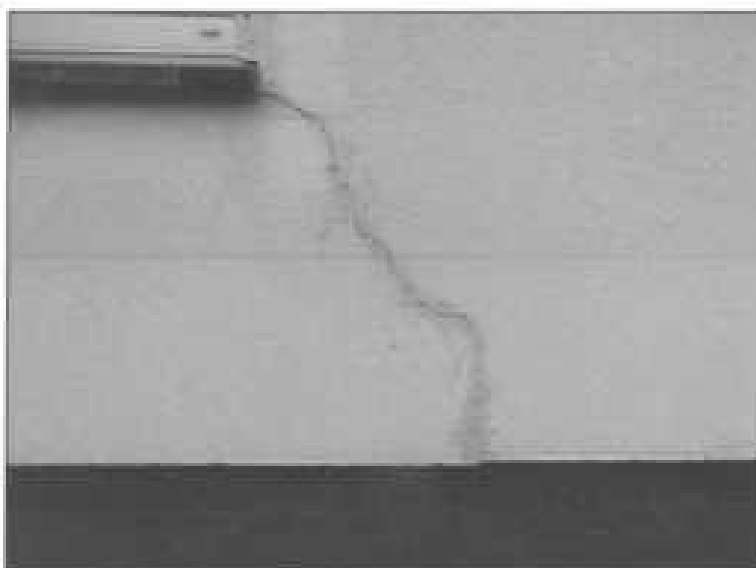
Riss in Fassade (Straßenseite)
